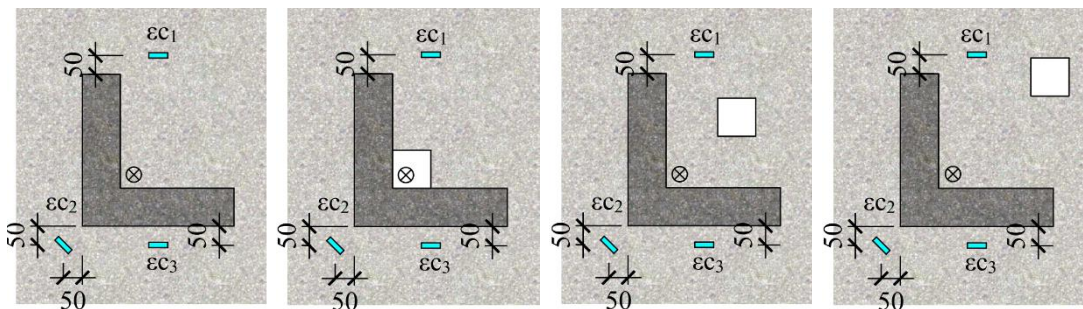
Disposição dos EERs no concreto na face inferior da das lajes
